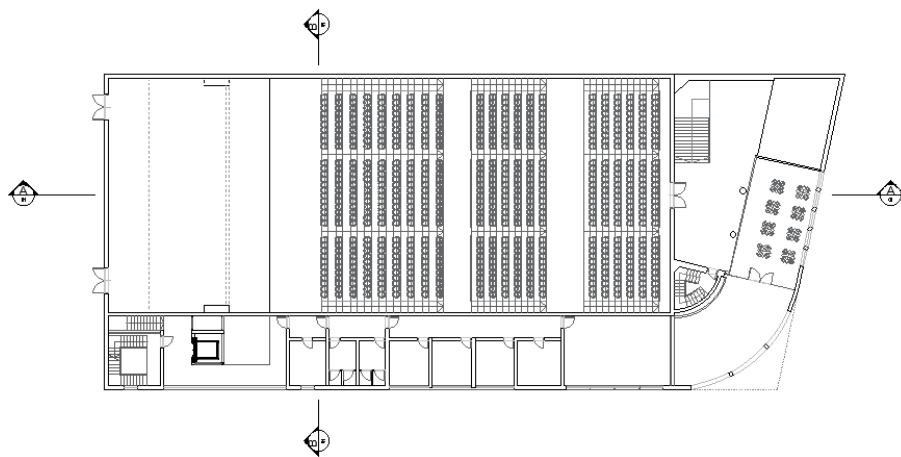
Planta da proposta de reabilitação do antigo cinema de Arrifana – piso 1
